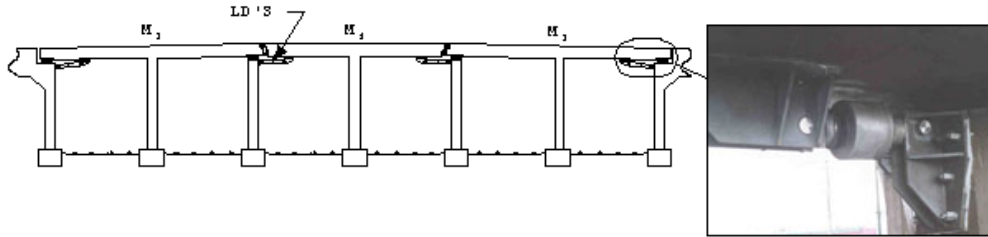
Ejemplo de control activo aplicado a un puente.
